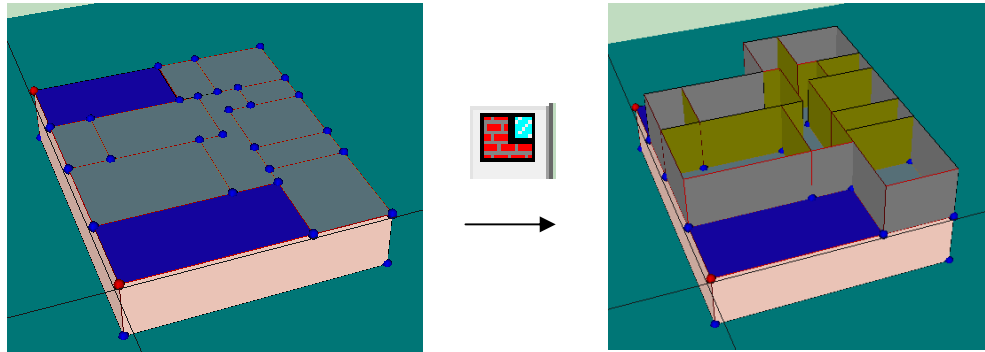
Transformación de 2D a 3D en la planta baja.
